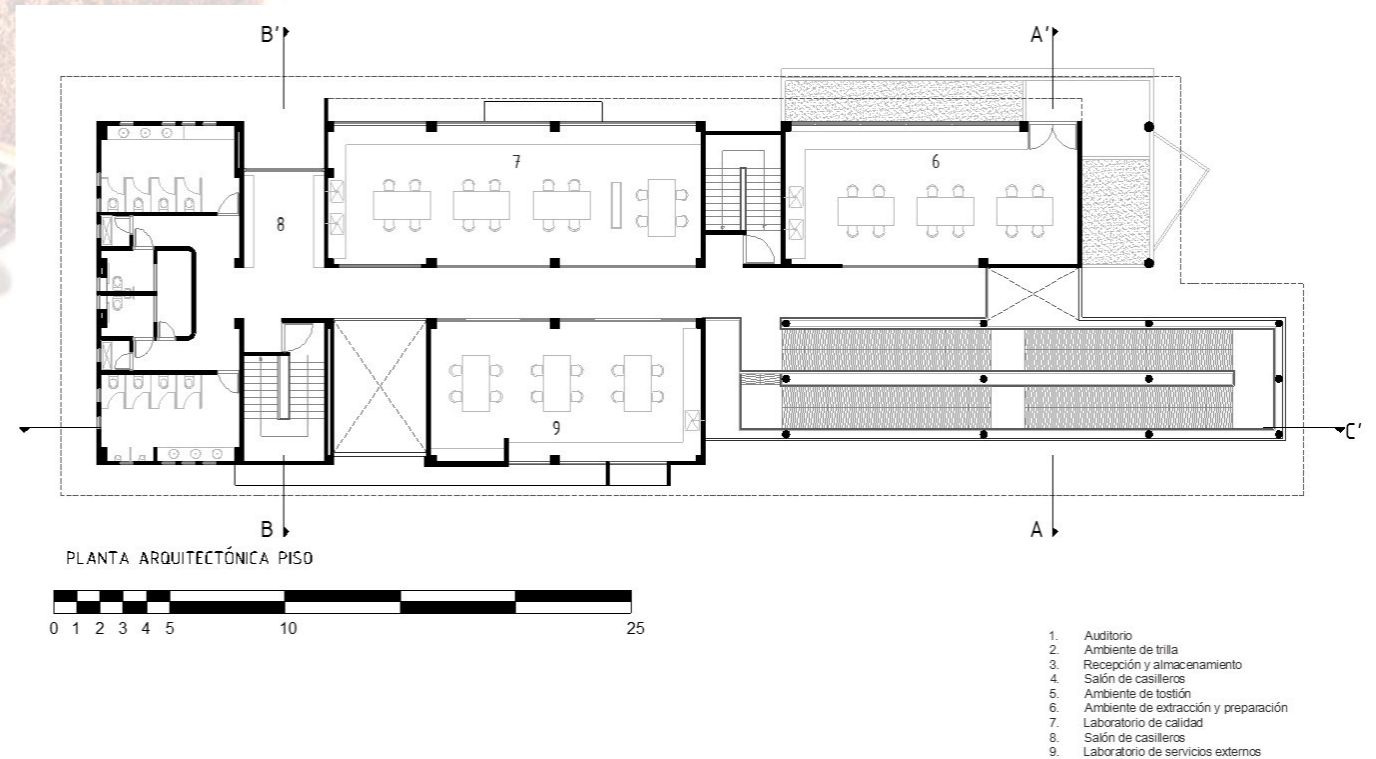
Planta arquitectónica segundo nivel, fuente: Archdaily.com, 2018
